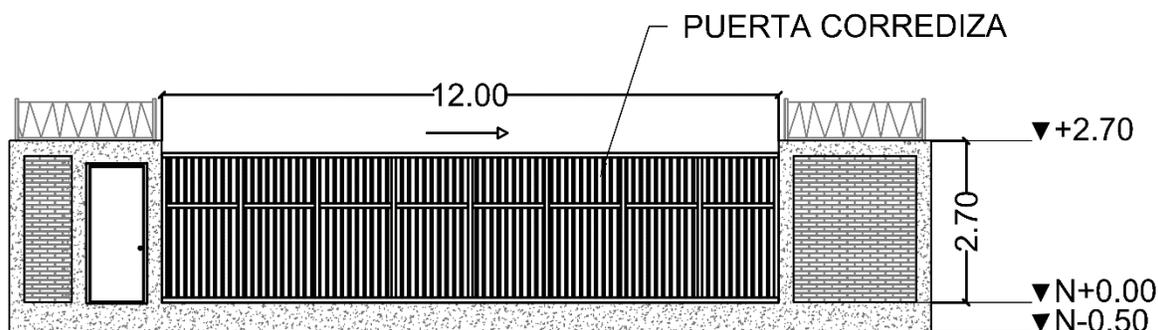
Detalle de cerramiento y puerta vehicular principal
